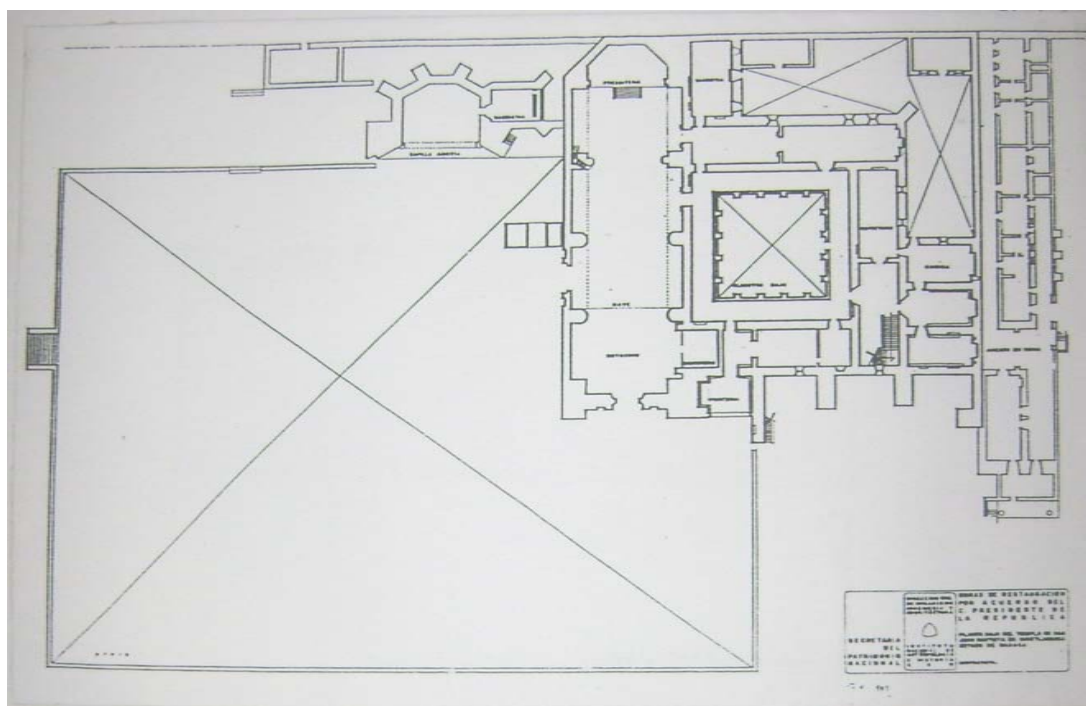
Plano del conjunto conventual de Coixtlahuaca (Planta baja). Se muestra con más detalle el complejo religioso. En Vences Vidal, p. 237.
